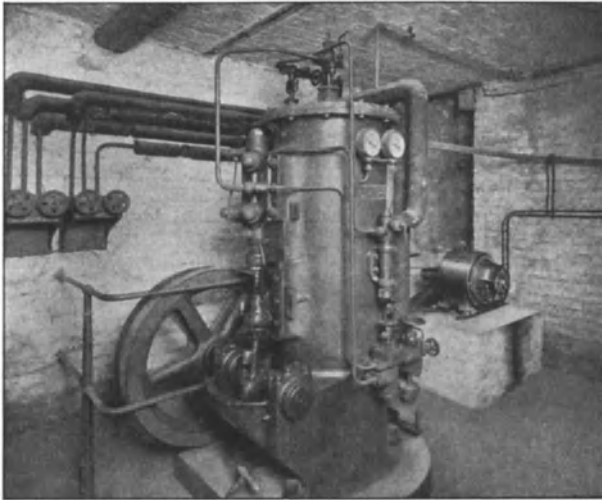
Kühlmaschine für eine Mietshausanlage mit in den Wohnungen verteilten Kühlschränken.
